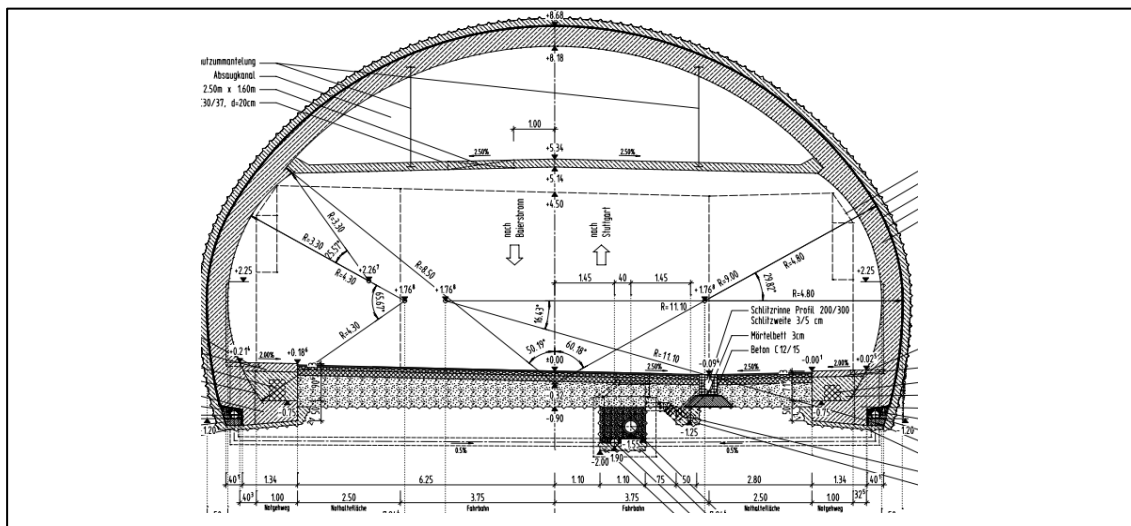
Regelquerschnitt Tunnel Freudenstadt – geschlossene Bauweise mit Pannenbucht und Zwischendecke
